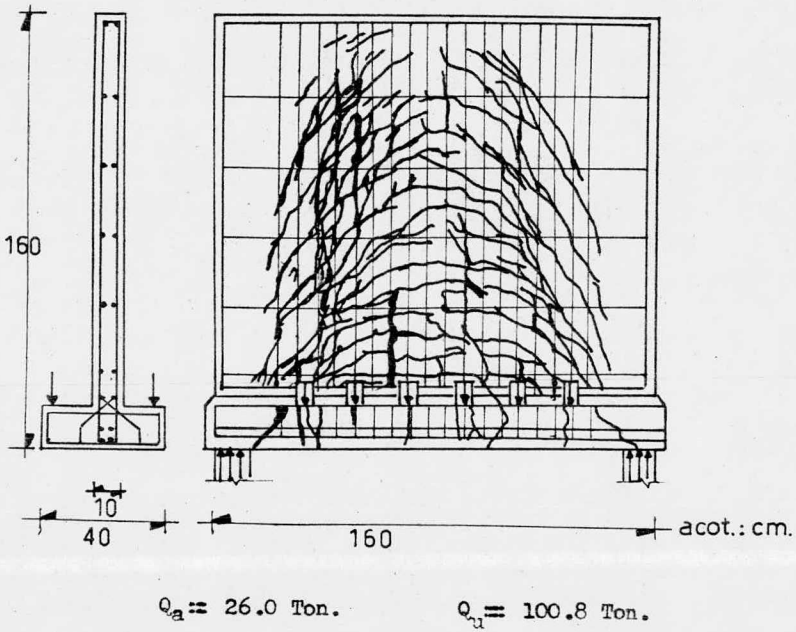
FALLA POR APLASTAMIENTO DE LOS APOYOS. VIGA DE UN SOLO CLARO CARGADA EN LA PARTE INFERIOR.
